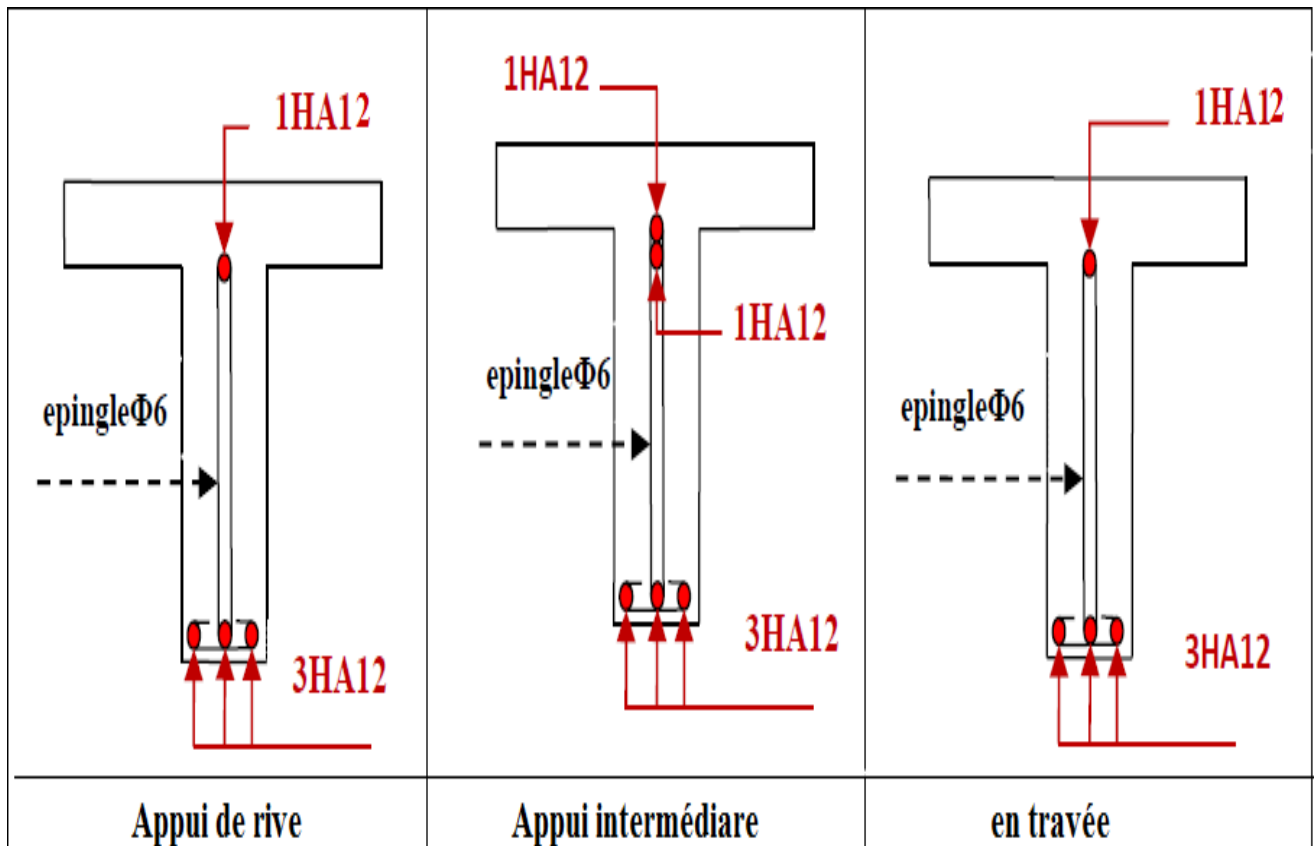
Schéma de ferrailage des poutrelles dans les différents niveaux.
